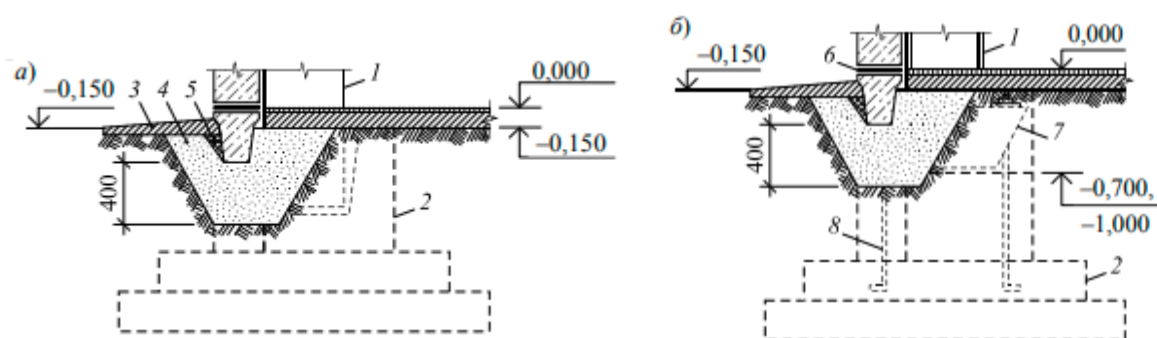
Отдельные фундаменты под железобетонную сборную (а) и стальную (б) колонну постоянного сечения для зданий без подвалов: 1 – колонна; 2 – фундамент; 3 – отмотка; 4 – обратная засыпка; 5 – глиняный замок; 6 – противопокапиллярная гидроизоляция; 7 – траверса; 8 – анкерный болт
